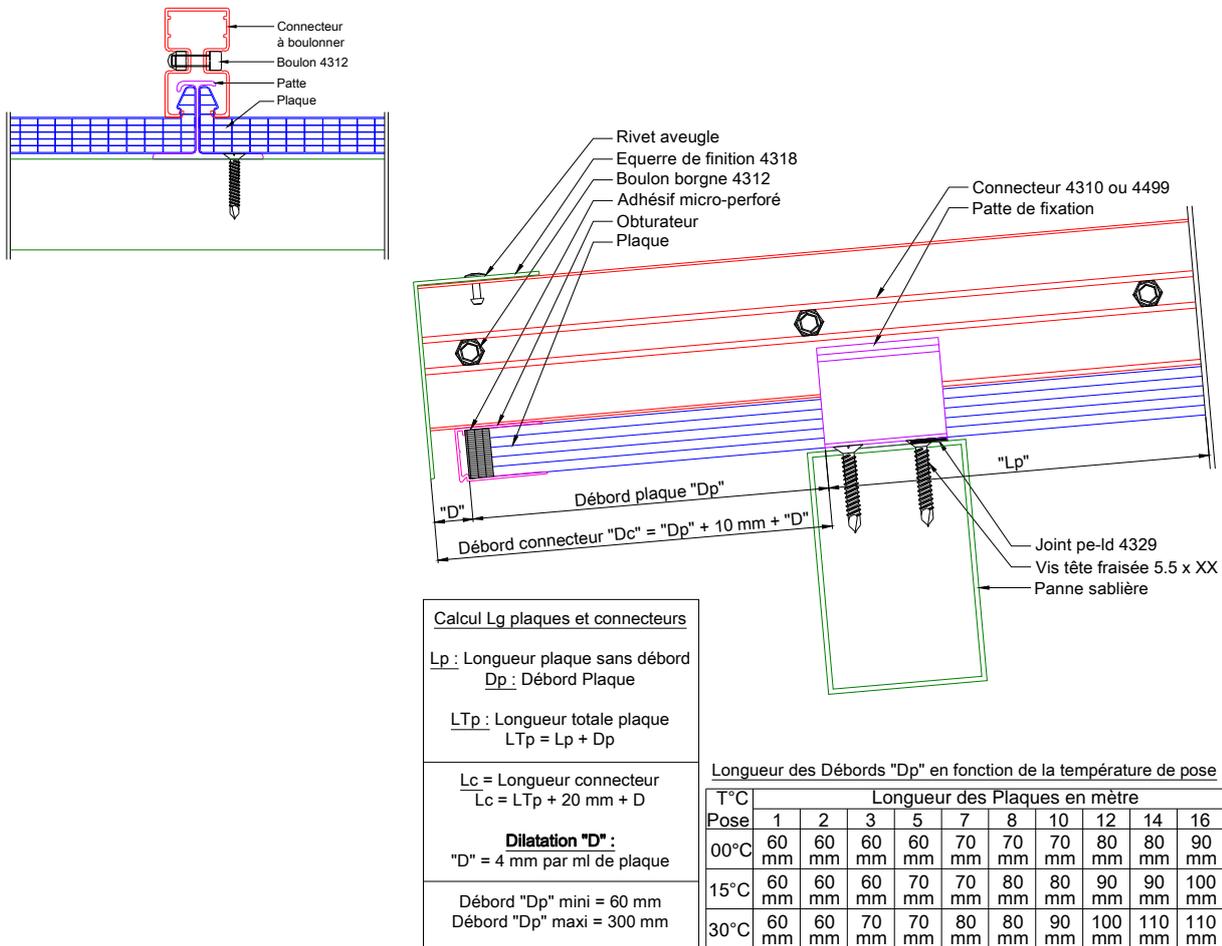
Principe de pose à l'égout avec connecteurs en aluminium à boulonner 4310 ou 4499
